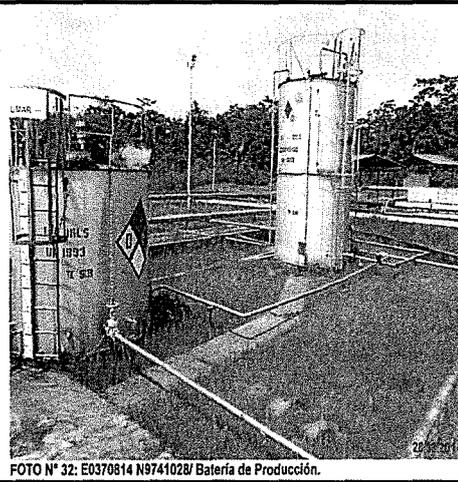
E0370814 N9741028/ Batería de Producción.
